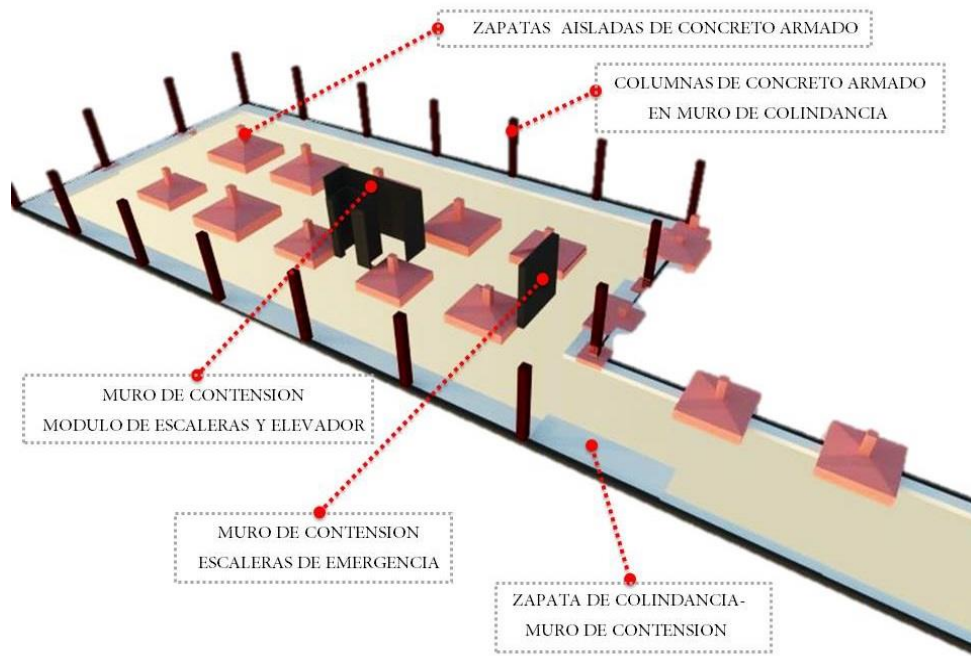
Modelo 3D de Zapatas aisladas. Autor: Carmen Lopez
